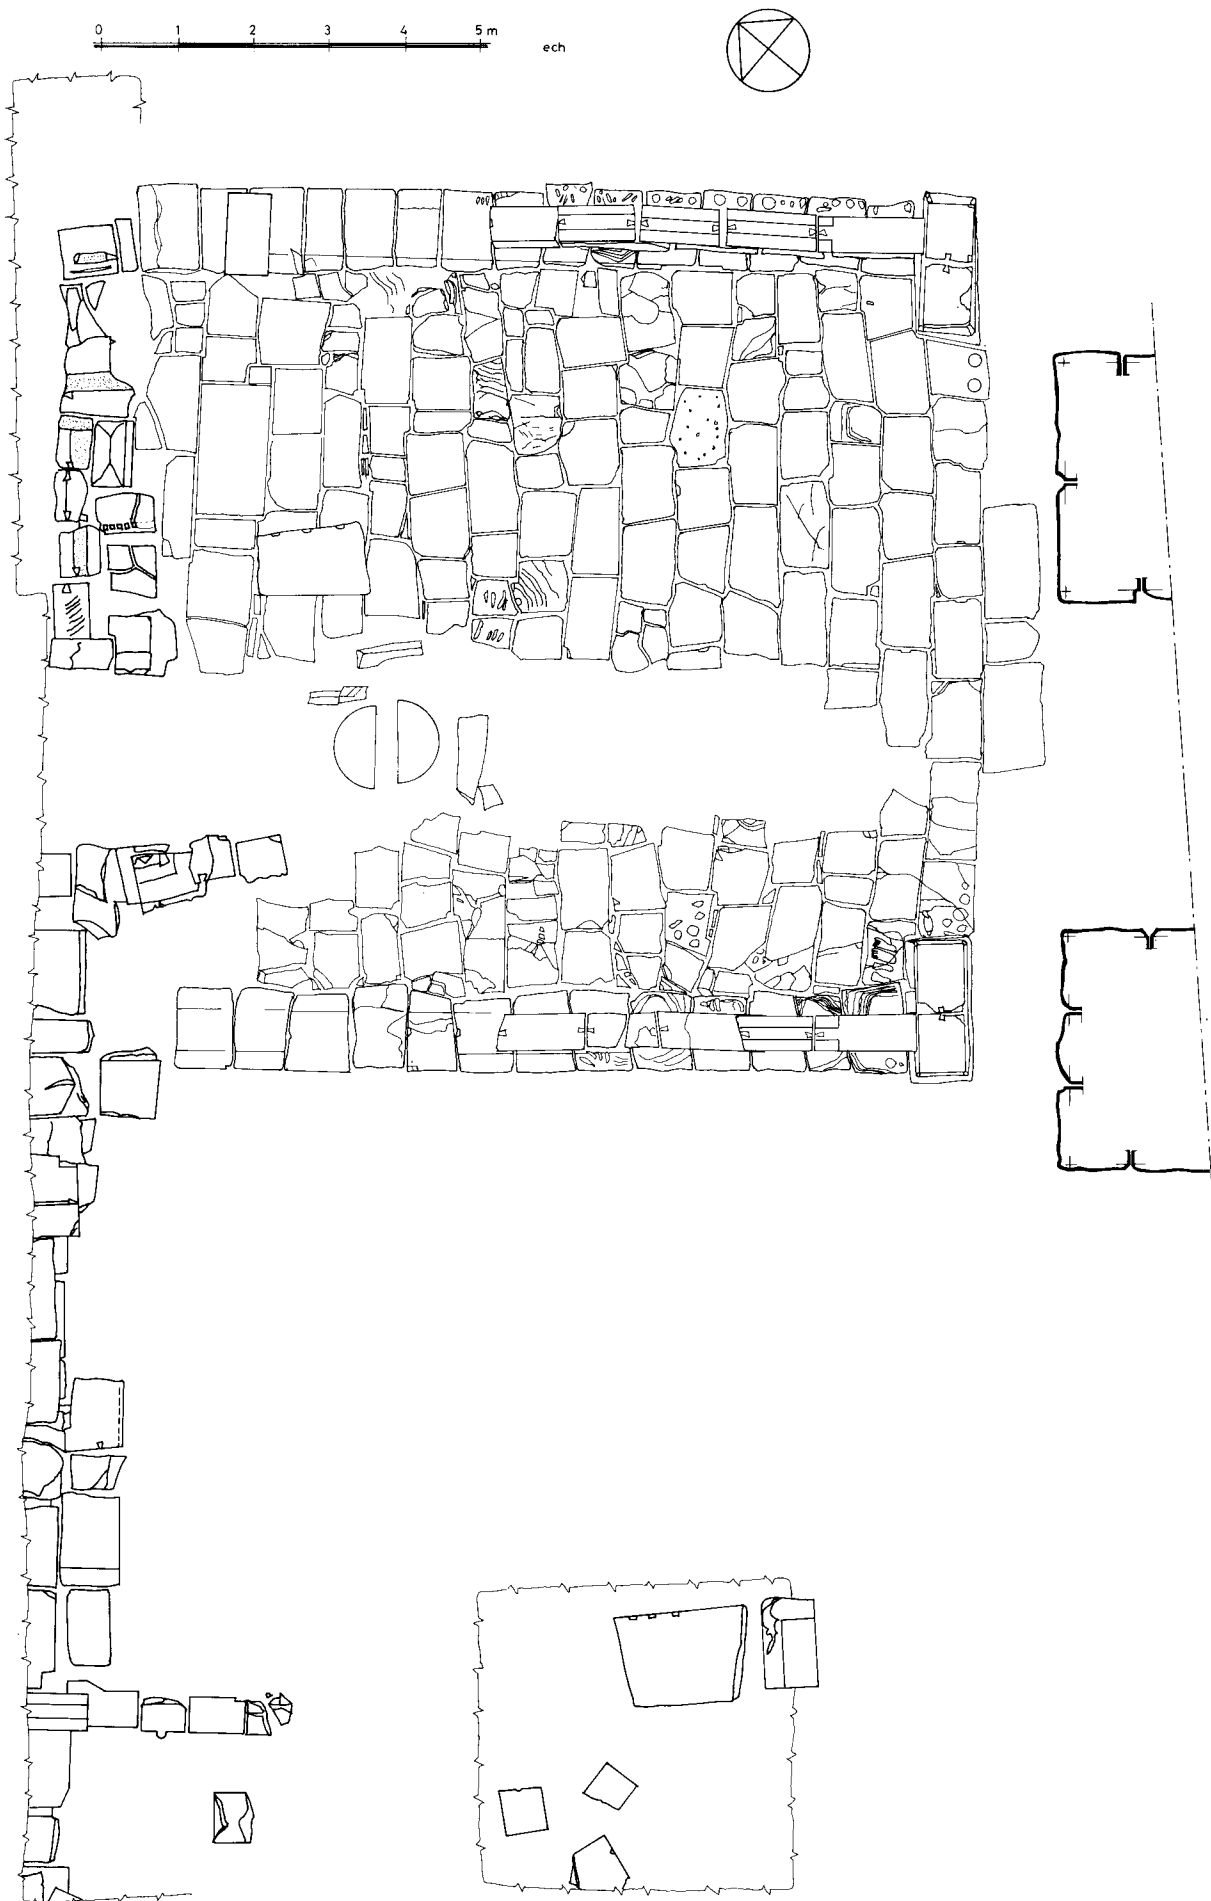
Plan de la rampe avec amorce de la porte P.
